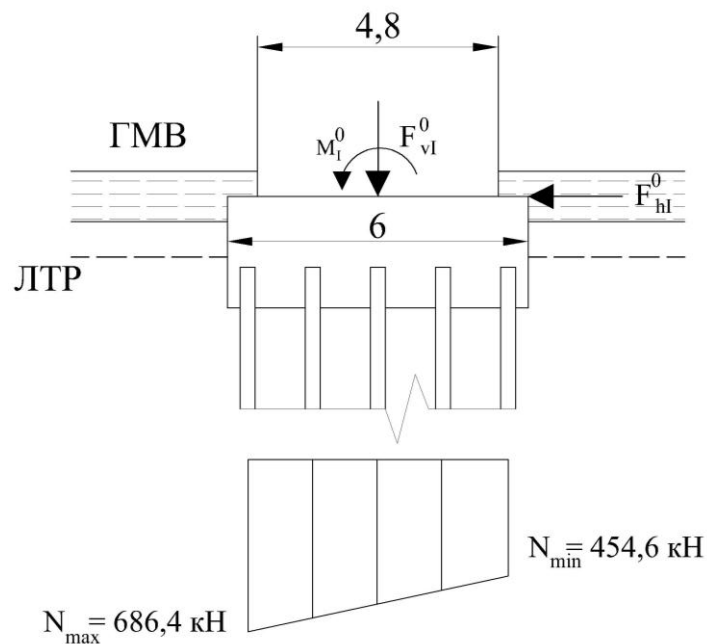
Схема свайного фундамента с расчетными нагрузками на крайние сваи
